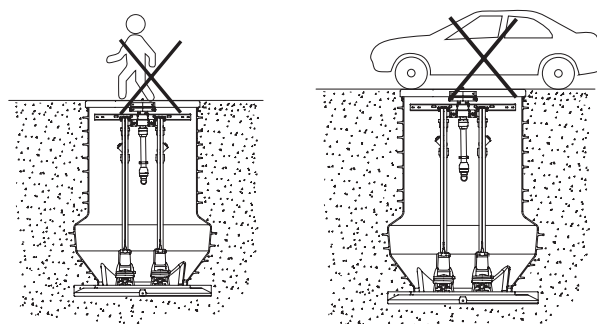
Крышки не рассчитаны на нагрузку от пешеходов и транспортных средств
